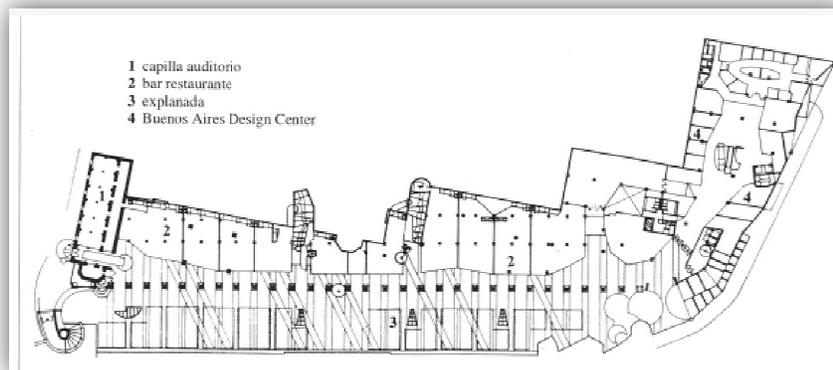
Planta arquitectónica Centro Cultural Recoleta. Fuente:
